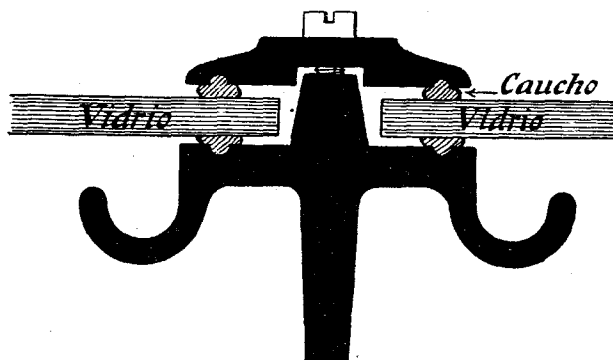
Hierro y junta, sistema Hardy, para cubiertas de vidrio.
